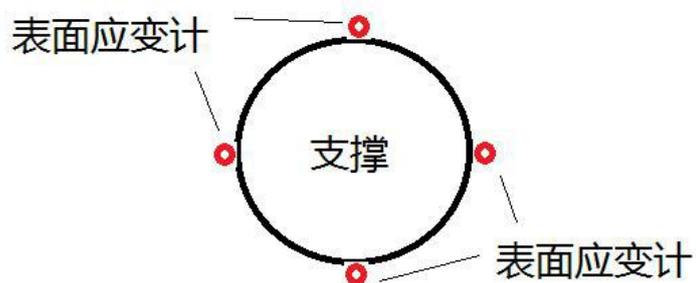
钢支撑轴力监测表面应变计布置示意图
